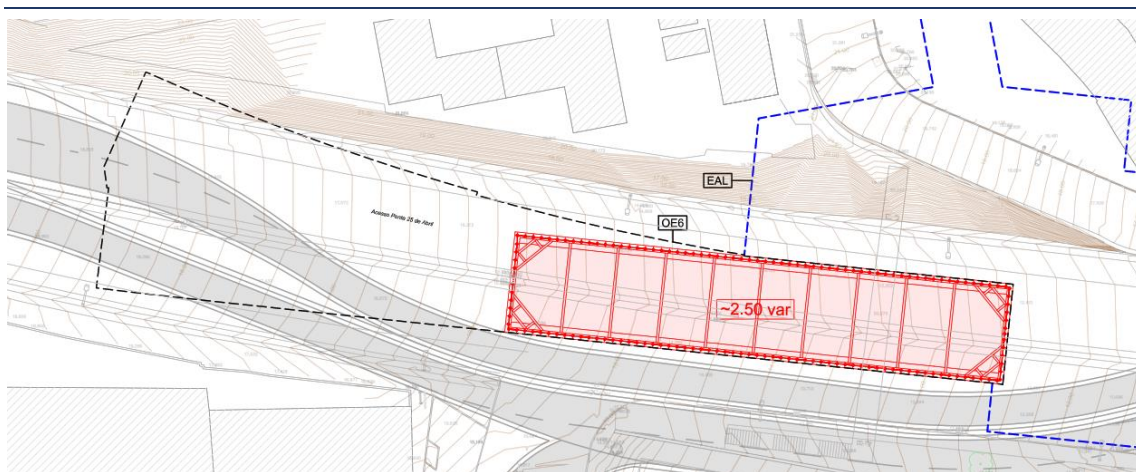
Planta de Dimensionamento Contenção Provisória – 1ª Fase de escavação
